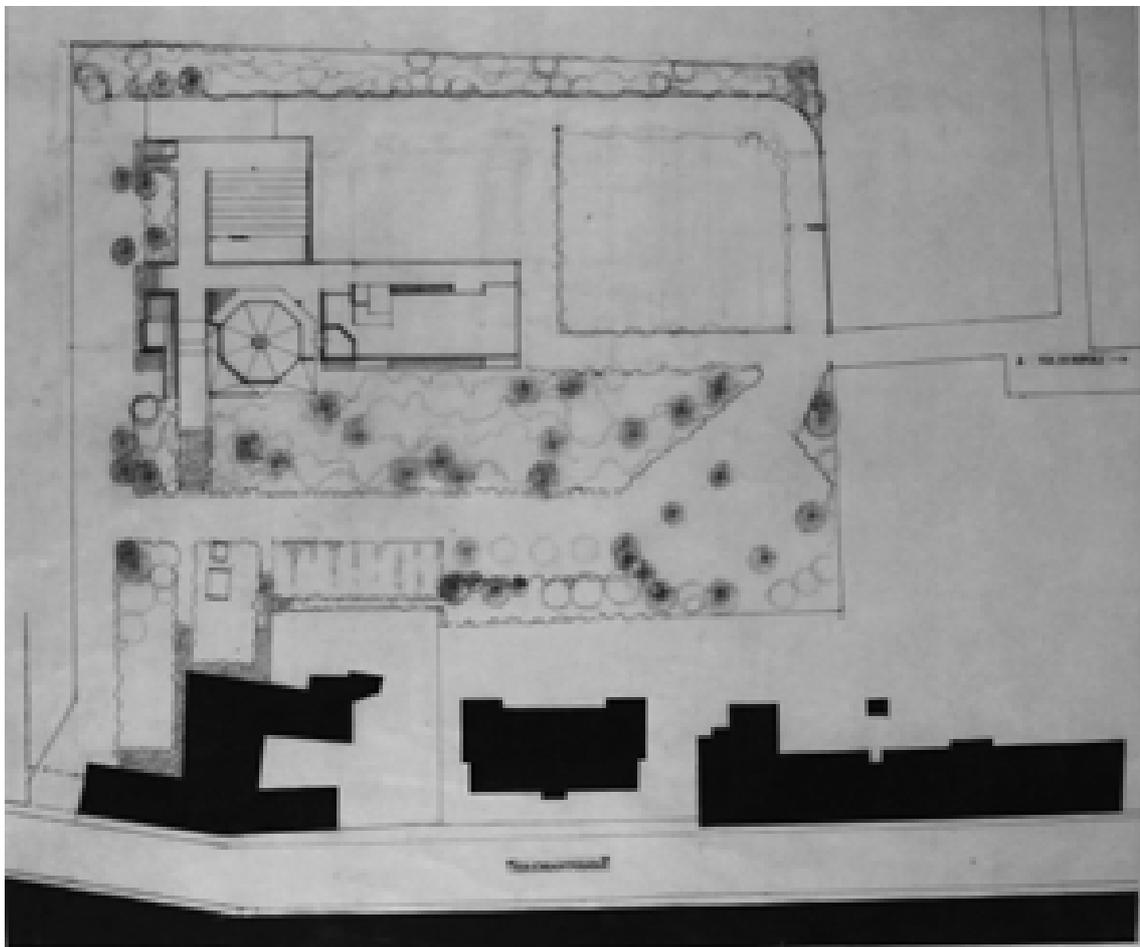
Planimetria, stato futuro – 23/10/1996 (AABS-64_64)
